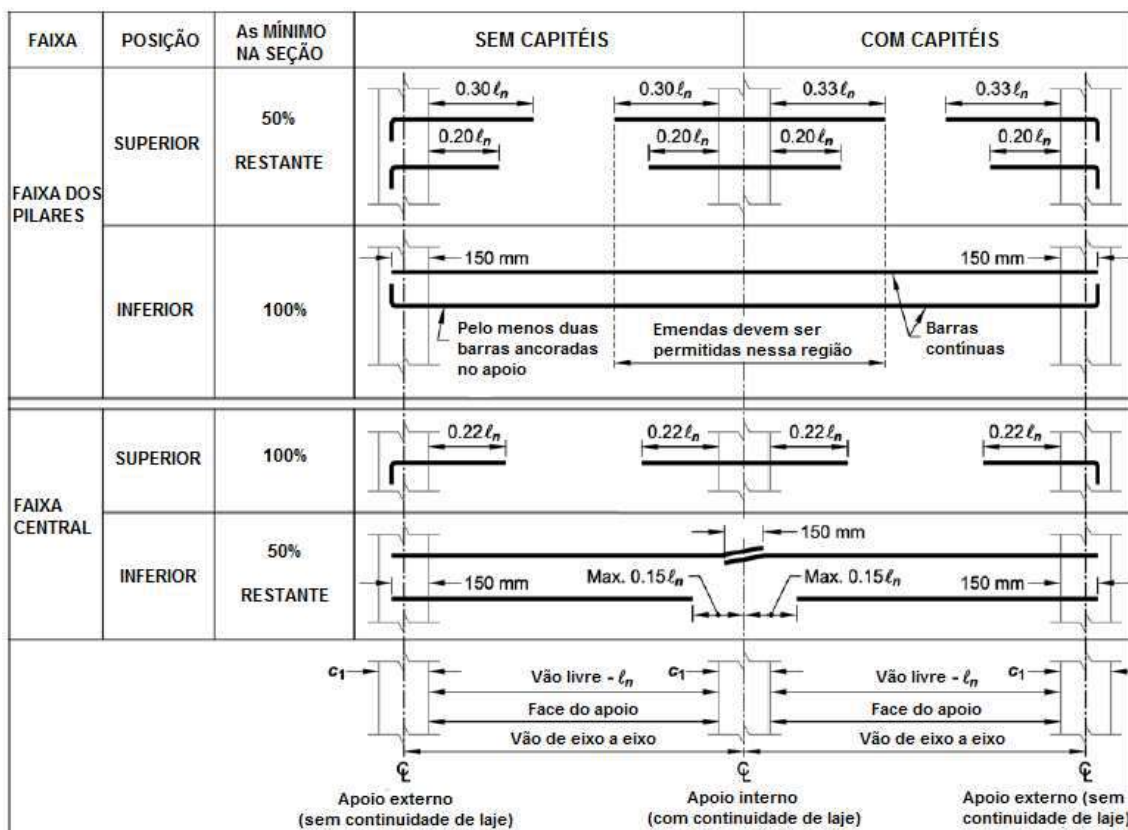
Disposição das armaduras contra colapso progressivo nas lajes de concreto armado apoiadas em pilares (ACI 318-14)
